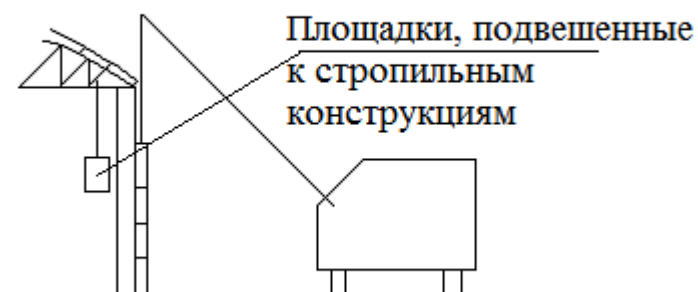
Монтаж стеновых панелей с подвесных площадок
